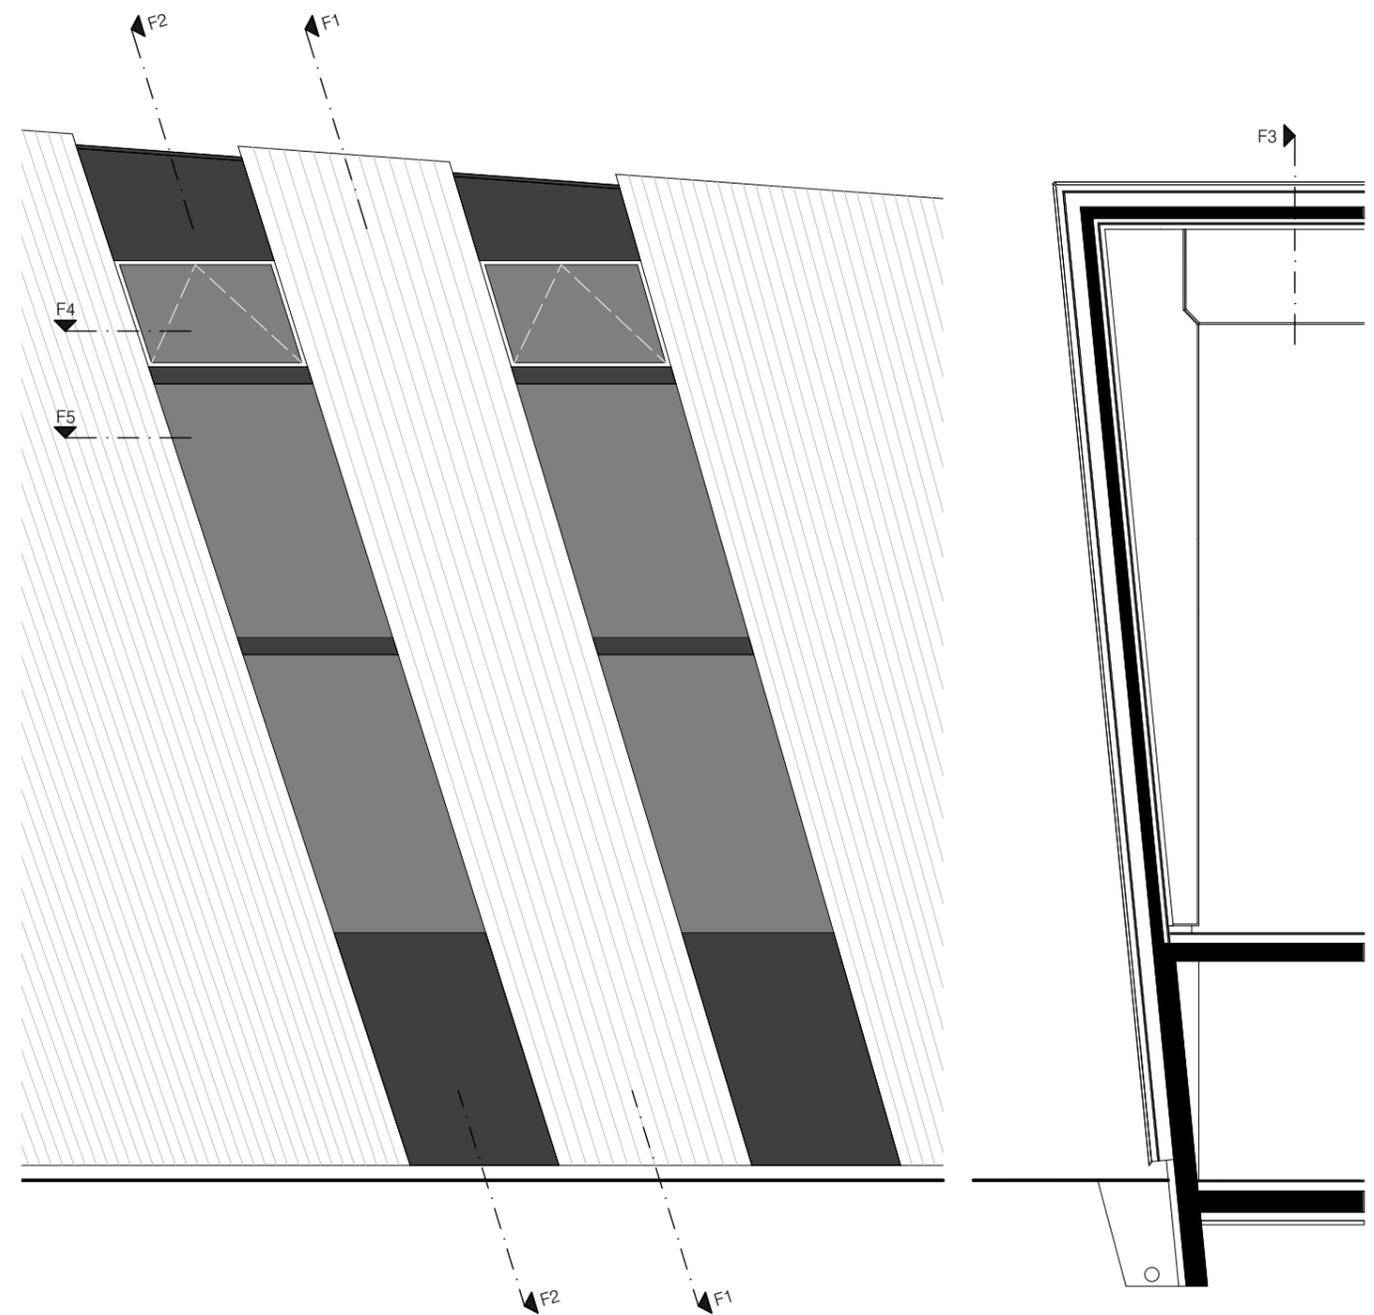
Übersicht Fassadenschnitt Sporthalle 1:100
